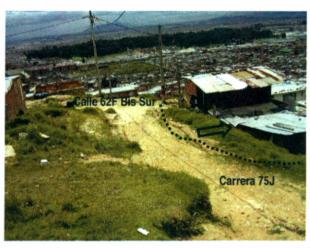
Zona I escarpe principal del deslizamiento. Nótese como se han depositado escombros en la cabeza del deslizamiento incrementando los esfuerzos cortantes.
